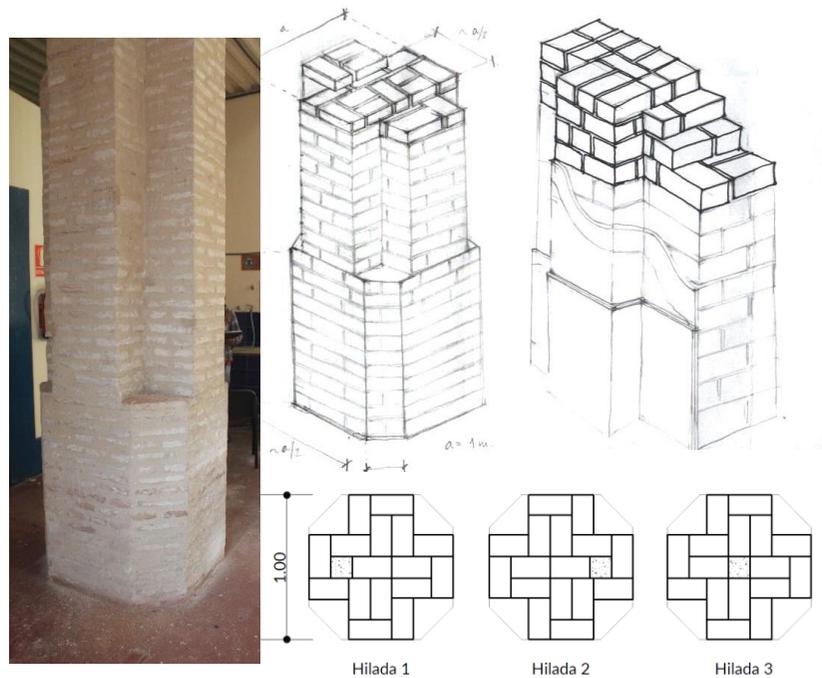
Fotografía y croquis sobre la teoría constructiva de los pilares cruciformes de fábrica de ladrillo y muro de fachada. Elaboración y foto del Autor.
